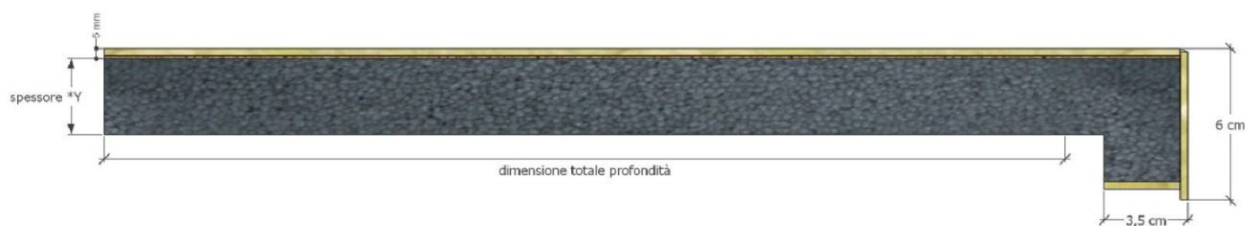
\_Dettaglio in sezione davanzale coibentato (Wall System)
